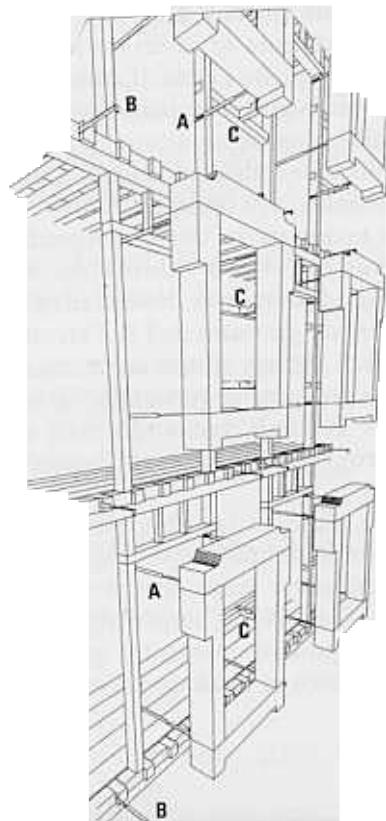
Disposição de sistema de gateamento metálico (a alvenaria é suposta invisível, para melhor compreensão das ligações):
